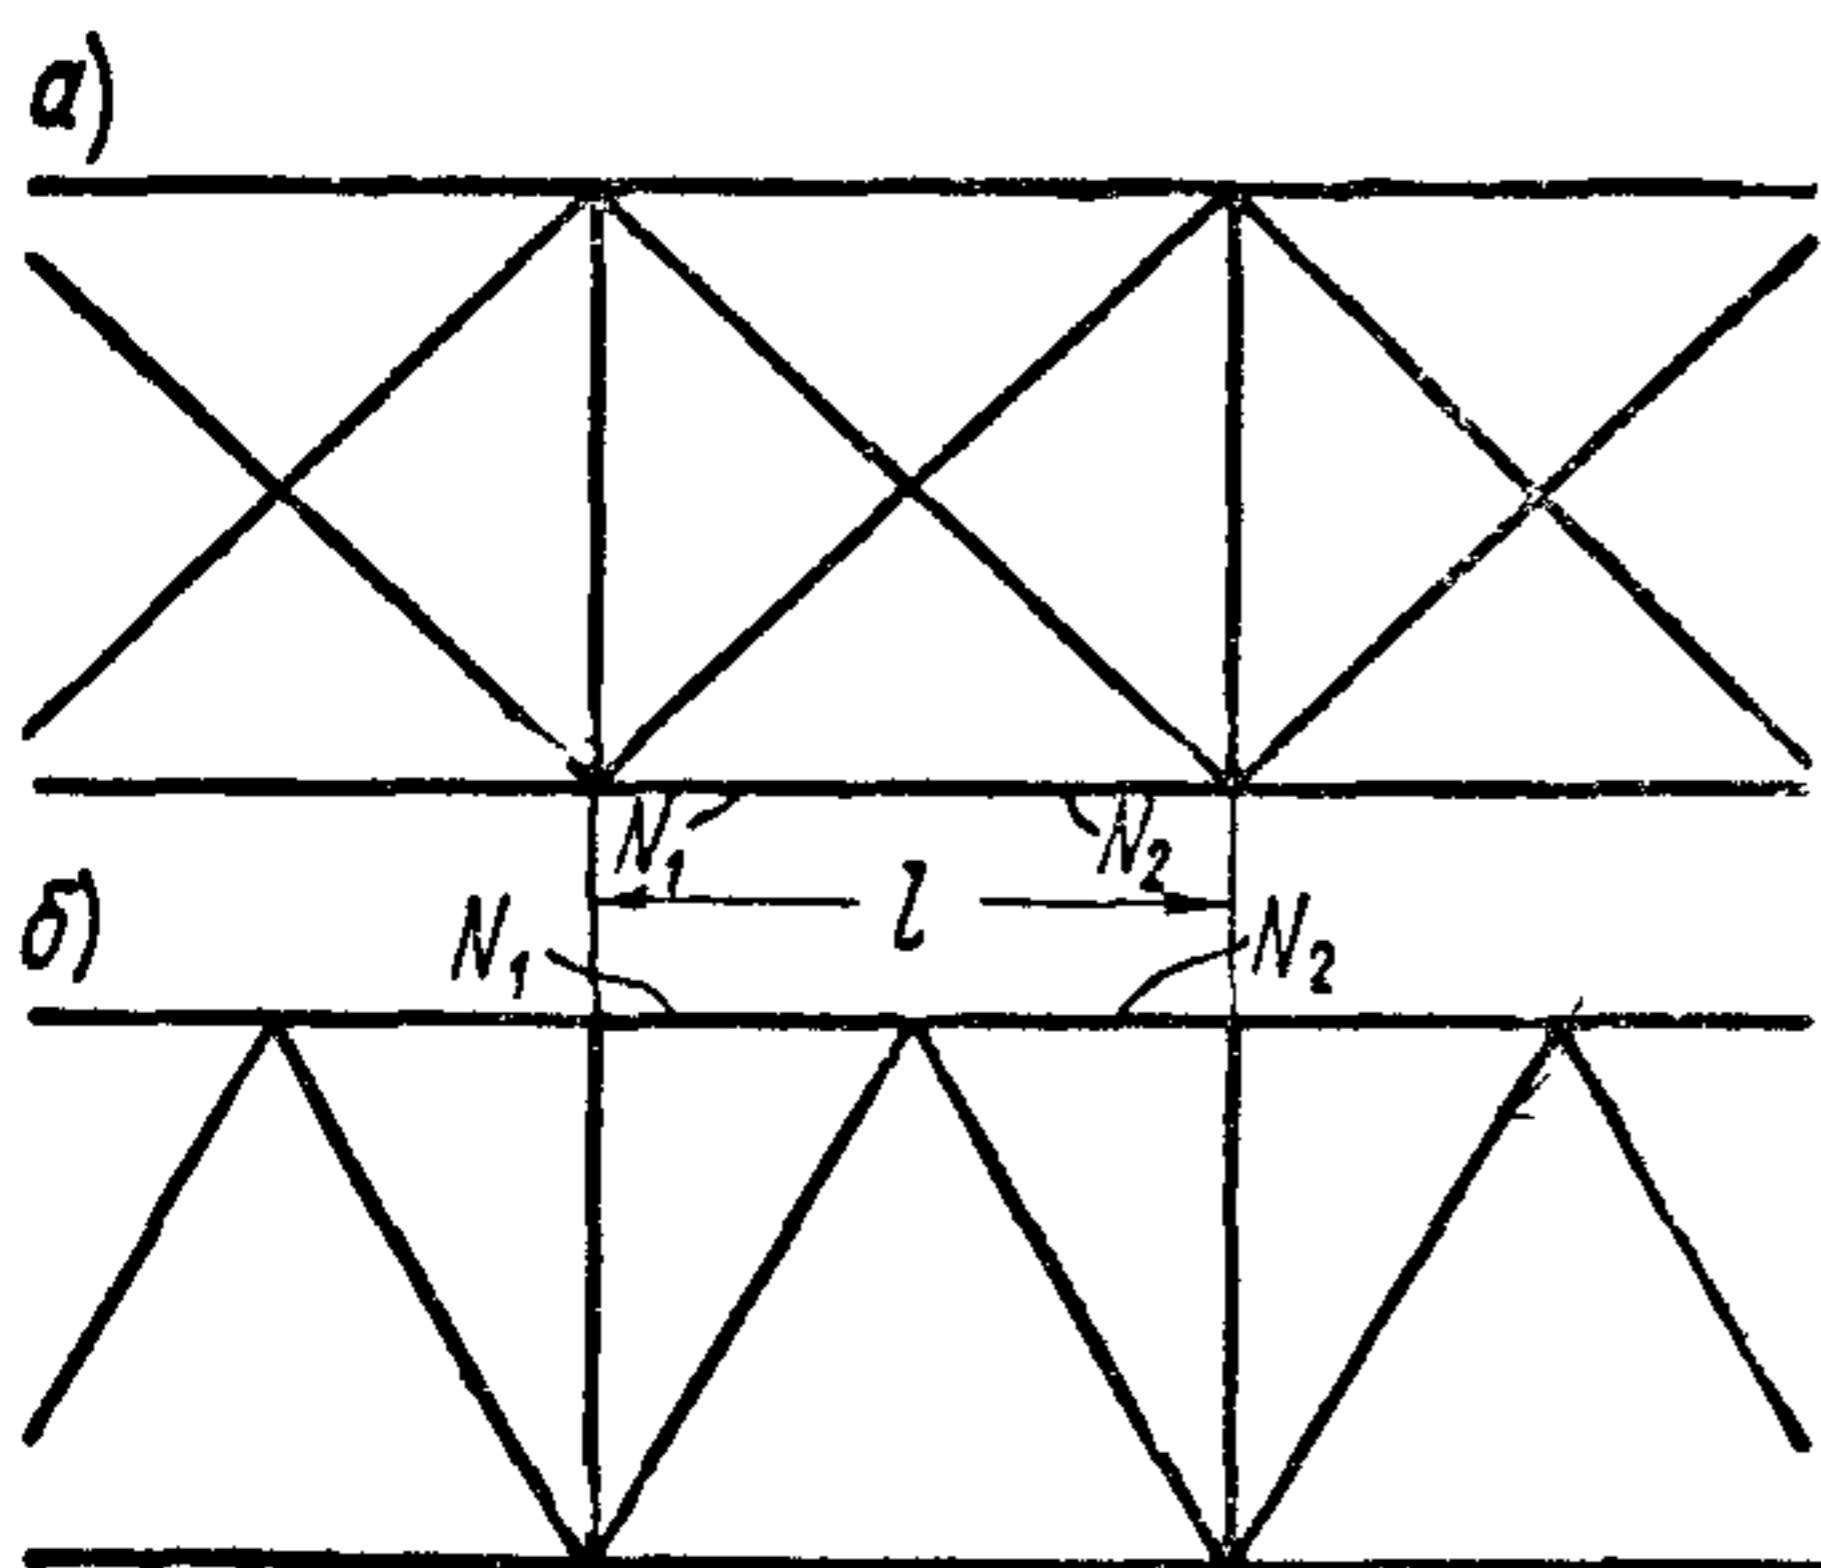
Схема решетки фермы (б) и связей (а) между фермами
